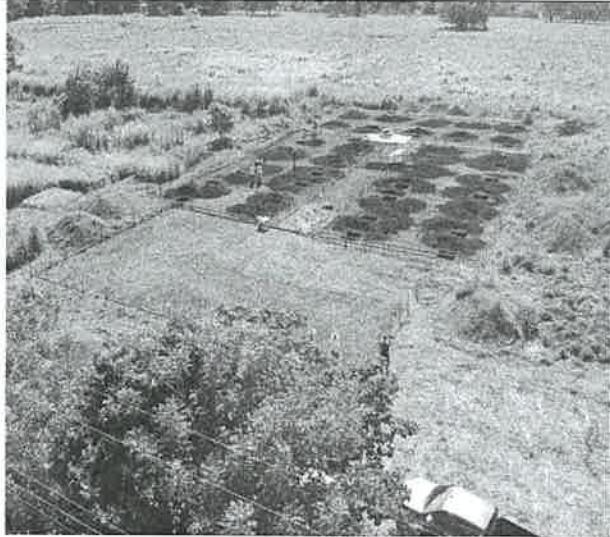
Vista de la apertura de los hoyos para las columnas.
